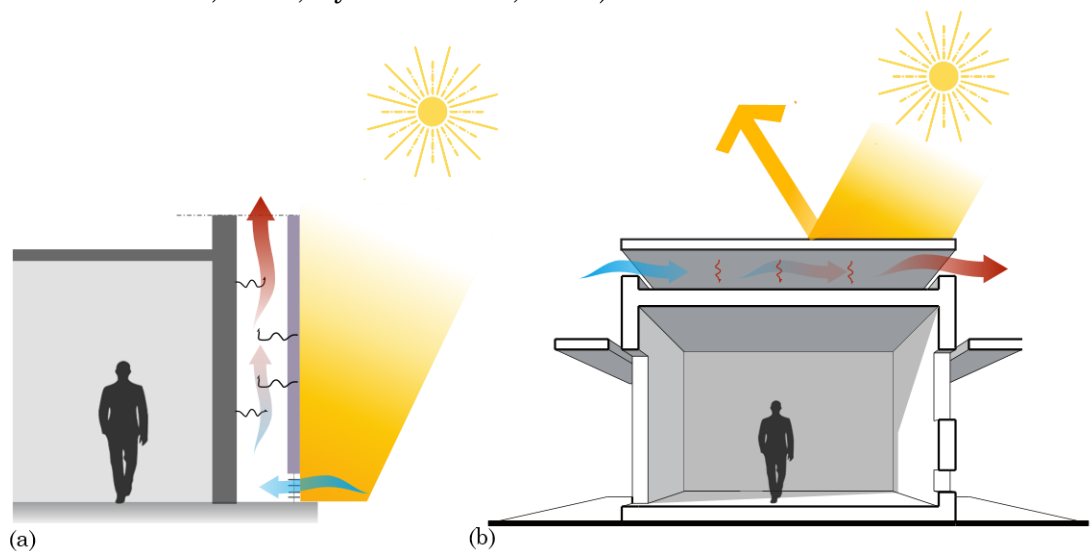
13 – (a) Section d'un mur à double peau, (b) Toiture ventilée.
